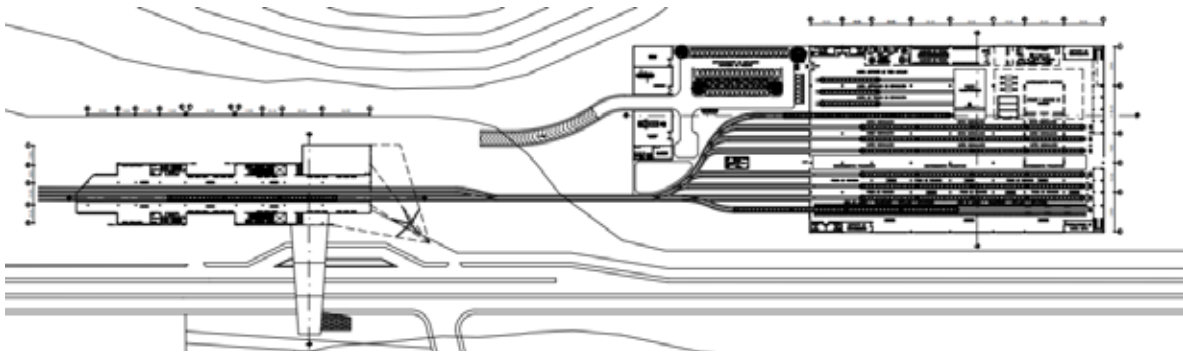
Planta 2 Propuesta Estación Terminal en la Ciudad de Rubio.
